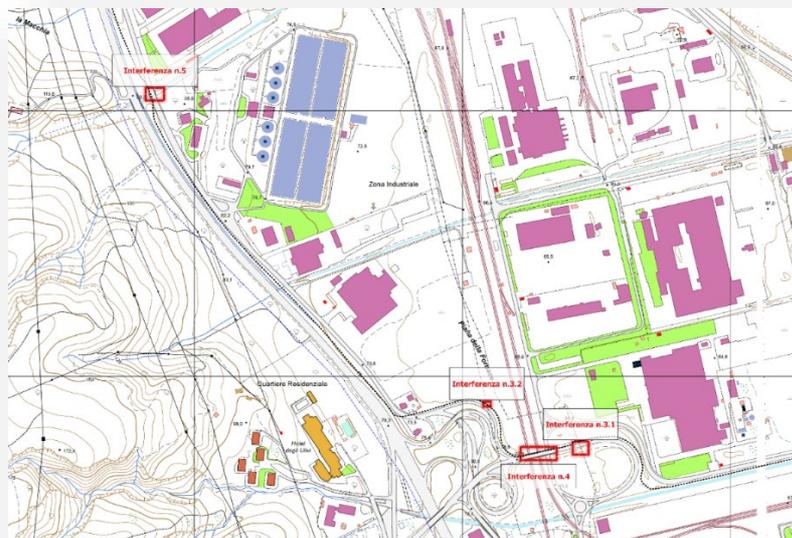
Estratto dell'elaborato A.12.a.21.b Planimetria con individuazione di tutte le interferenze
